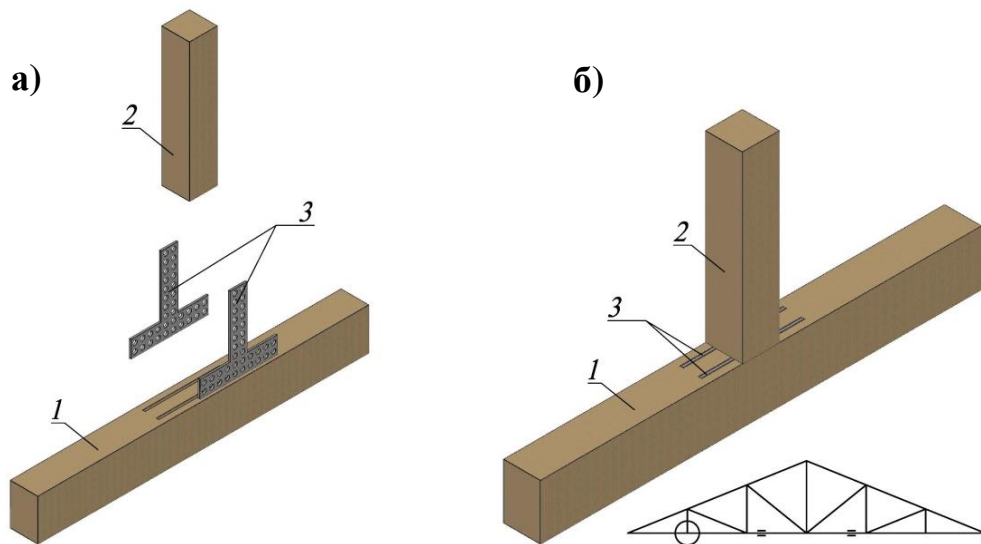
Узел соединения стойки с нижним поясом на плоских стальных стержнях в разобранном (а) и собранном (б) виде: 1 – нижний пояс; 2 – стойка; 3 – плоский стержень
